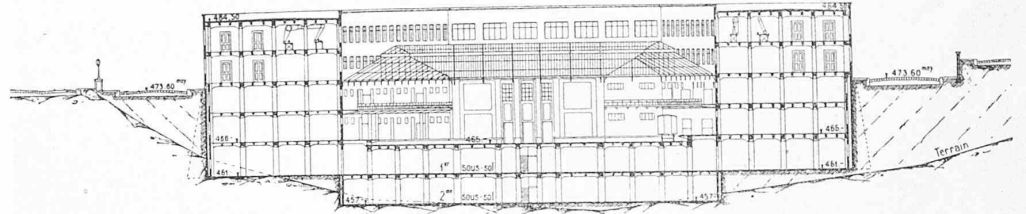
Coupe transversale sur la troisième terrasse. — Echelle 1 : 1000.
